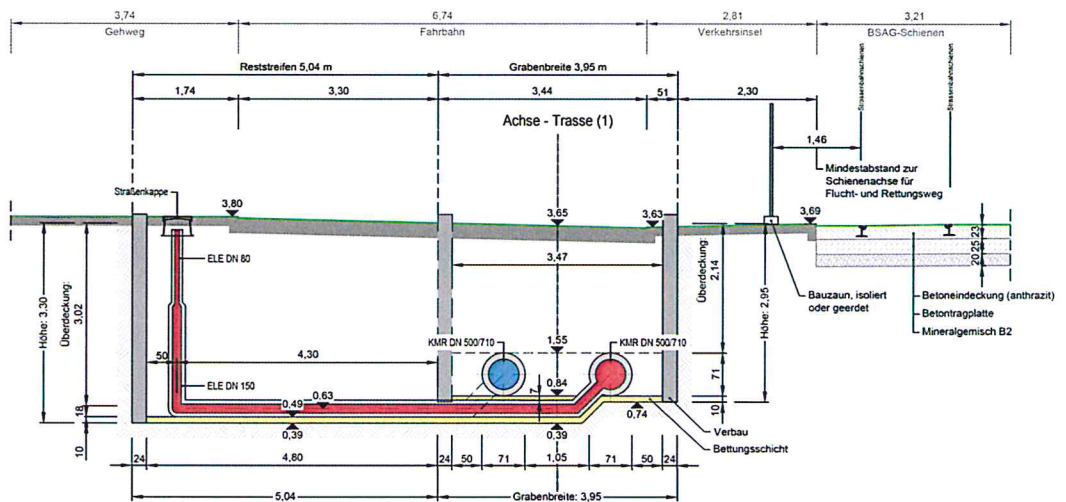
b Schnitt (23.2) Auszug aus dem Plan Nr. 4.23.2.2
